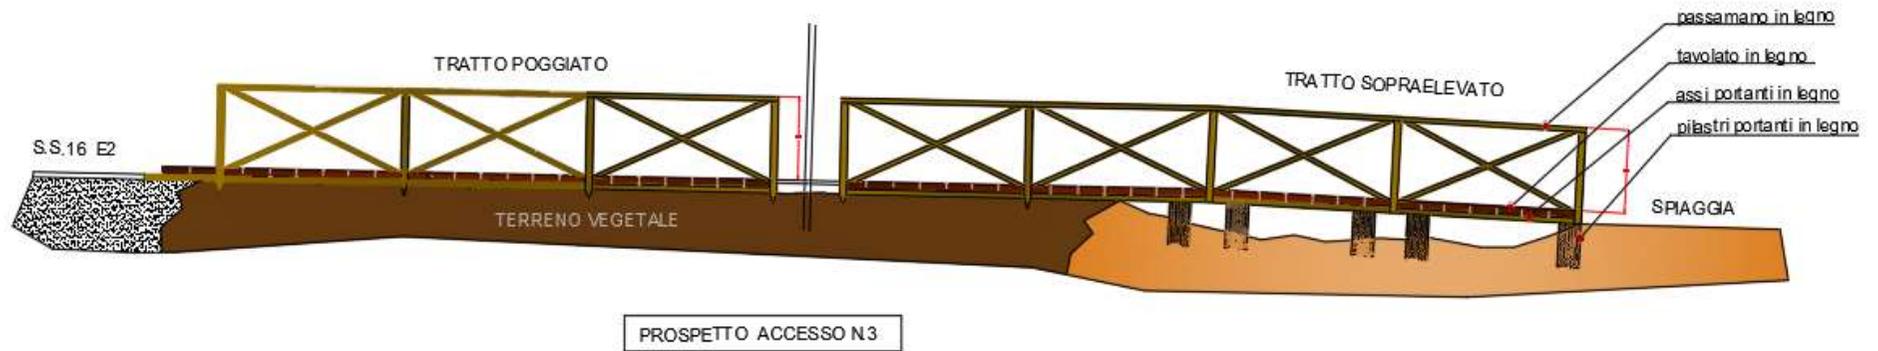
Prospetto tipo per accesso al mare n. 28
